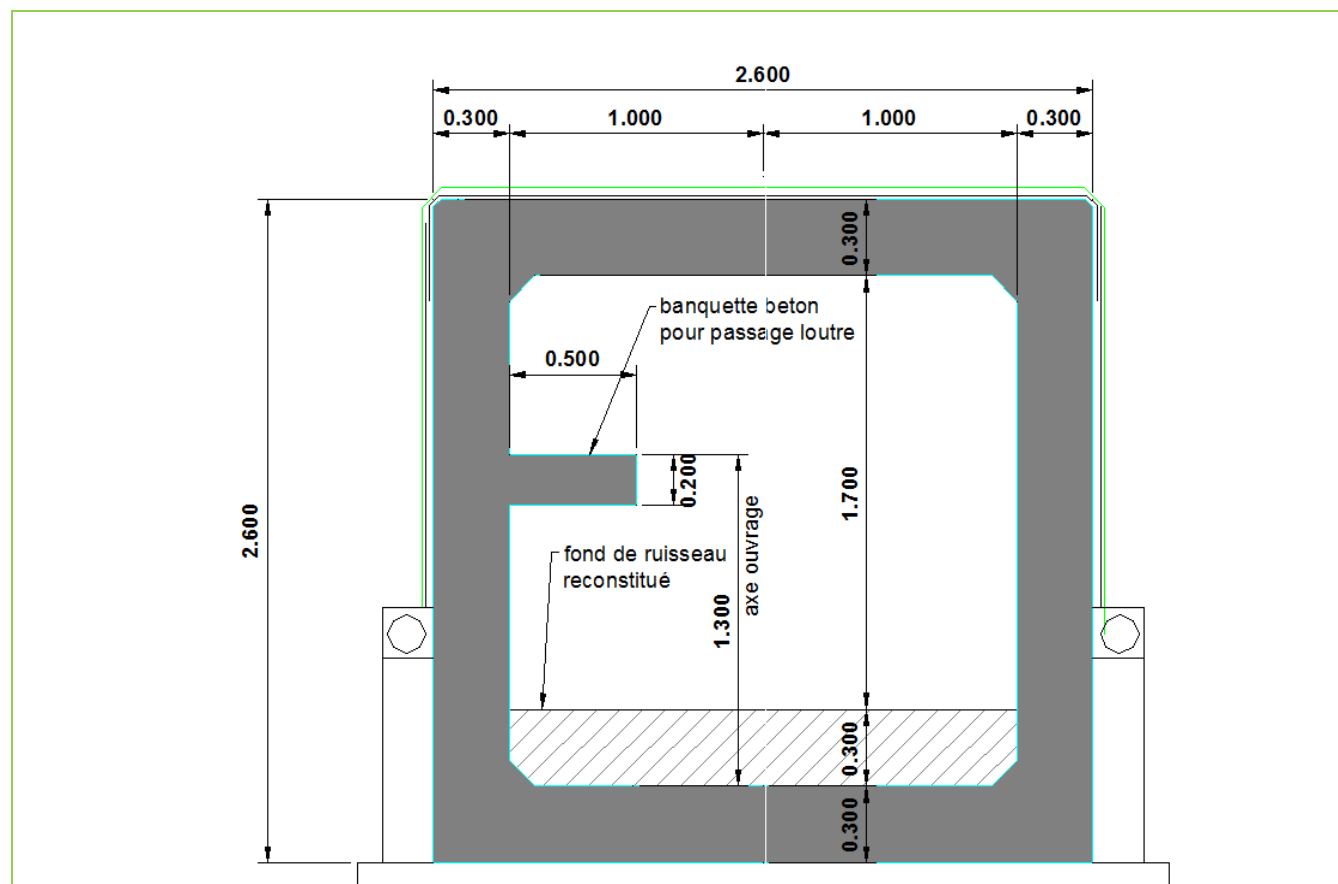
Coupe transversale de l'OH (source ARCADIS)
